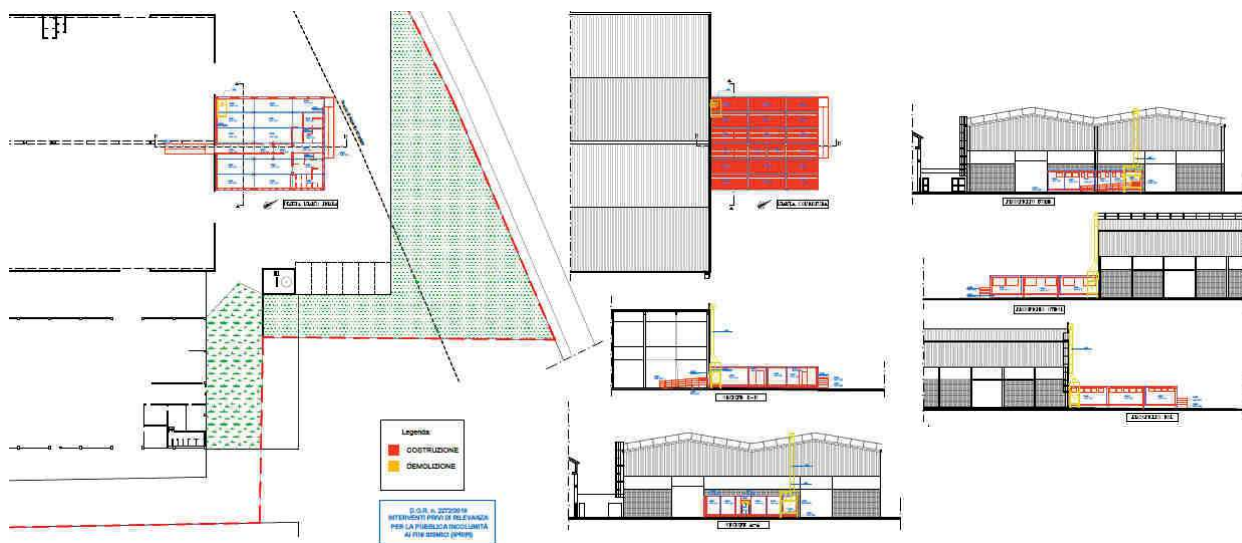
Planimetria e prospetti nord ed est dello stato di progetto
